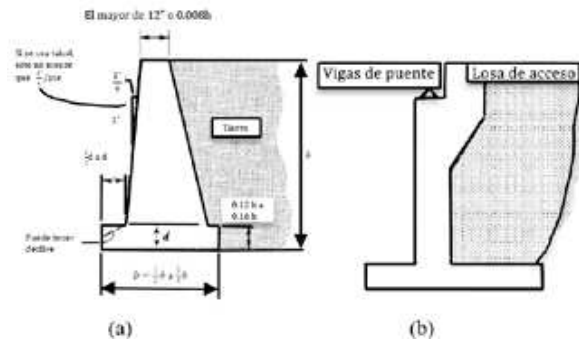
Esquema básico para diseño de los estribos del puente. (a) Sección muro a gravedad. (b) Sección con soporte de las vigas de acero [2].
